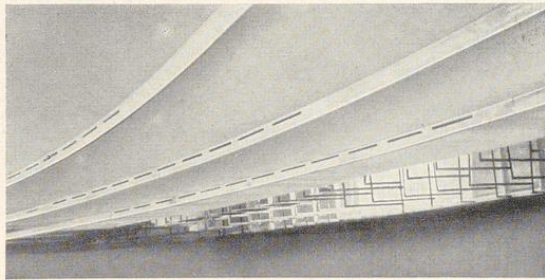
In die Decke eingebaute Entlüftungsschlitze aus Zürich
